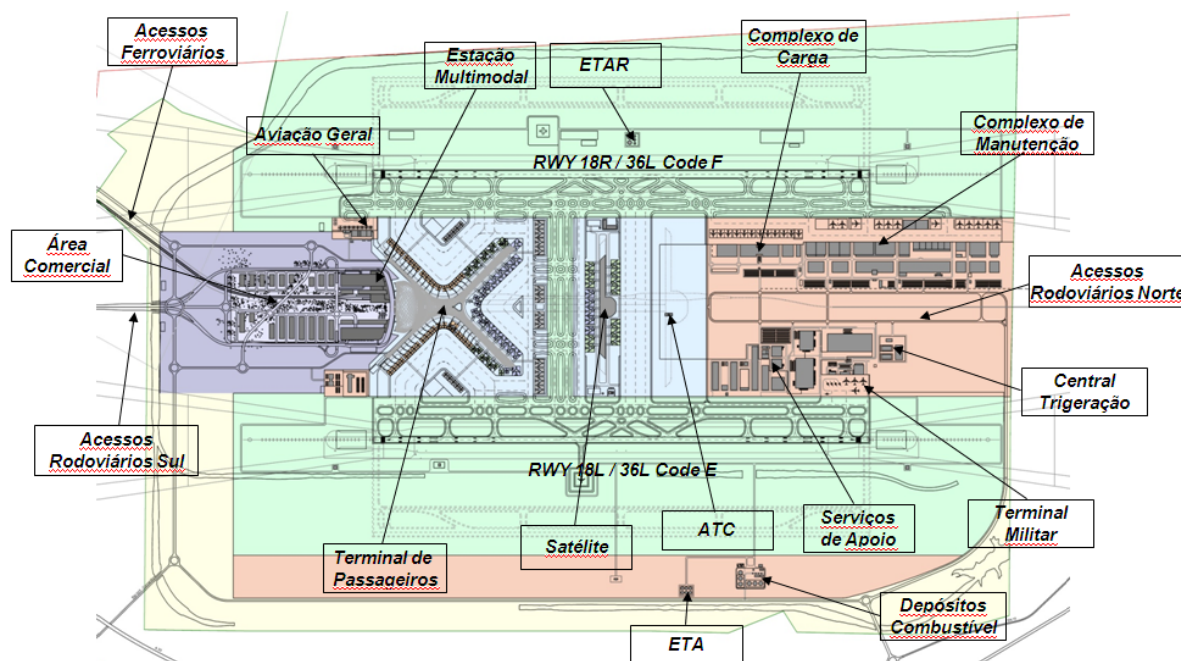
Configuração do NAL para o ano horizonte de projecto e principais infra-estruturas.
